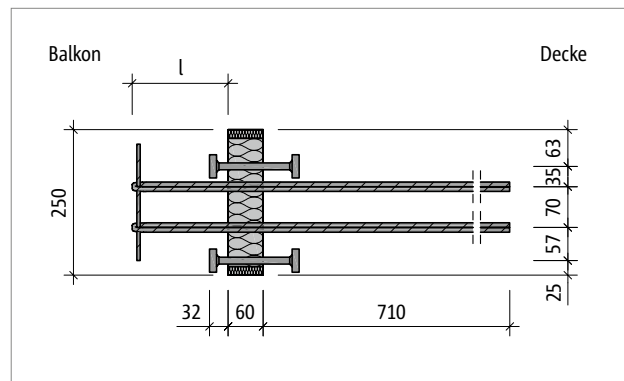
Schöck Isokorb® T Typ O-X60: Produktgrundriss
